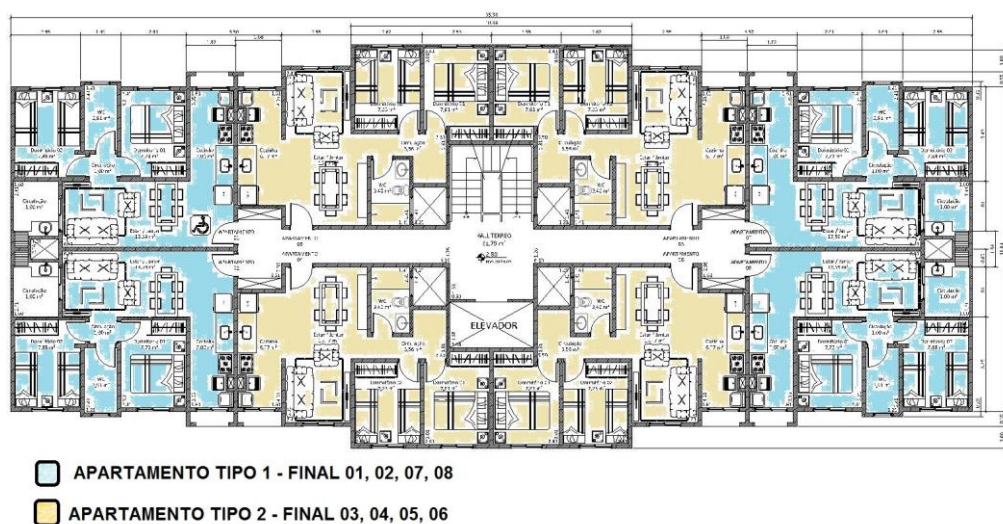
Pavimento tipo - Projeto 2. Fonte: RDB Construtora com intervenções.
